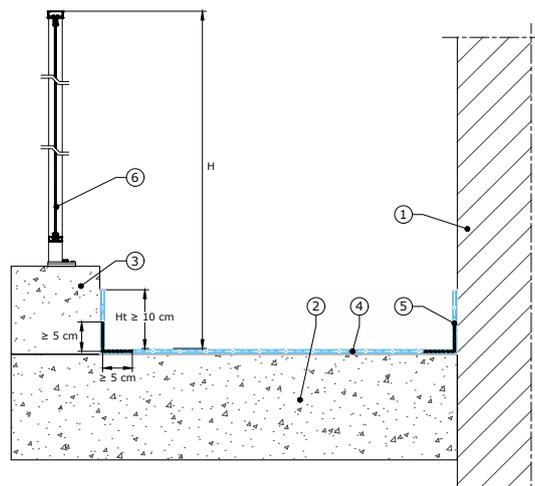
Garde-corps sur acrotère en béton - Exemple
